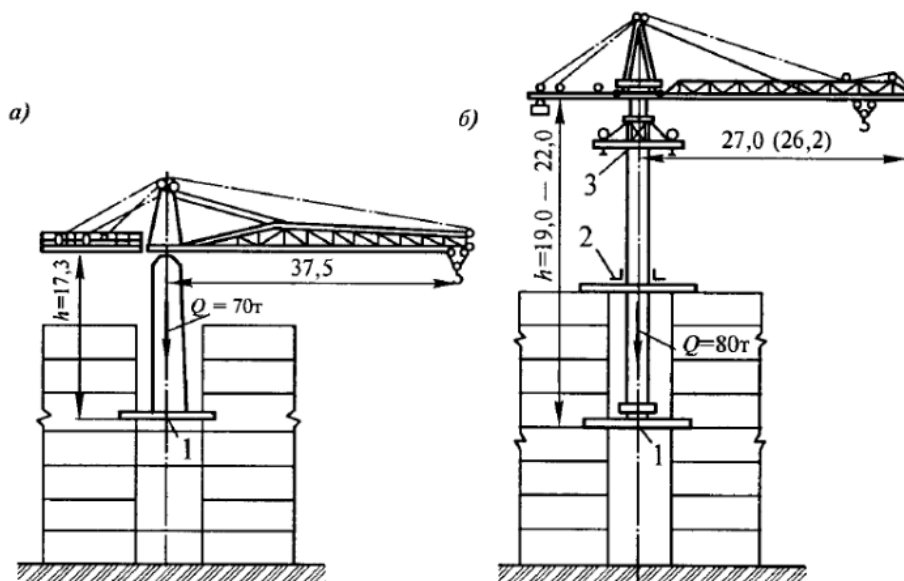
Схеми самопідйомних кранів для монтажу висотних будівель: а - крани типу УБК із затисканням у горизонтальній площині; б - крани типу СБК із защемленням у вертикальній площині; 1 - нижня опора; 2 - верхня опора для сприйняття горизонтальних реакцій; 3 - рухома обойма для самопідйому крана на наступну стоянку
